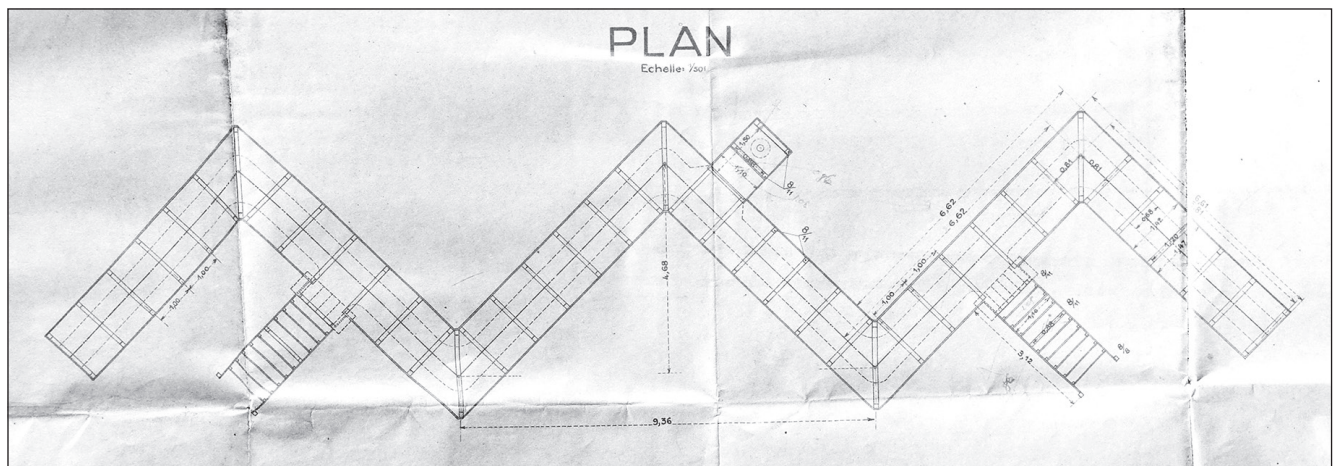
Plan d'un module de tranchée-abri permanente en bois pour Gagny, 1940. Arch. mun. Gagny, boîte 4.
